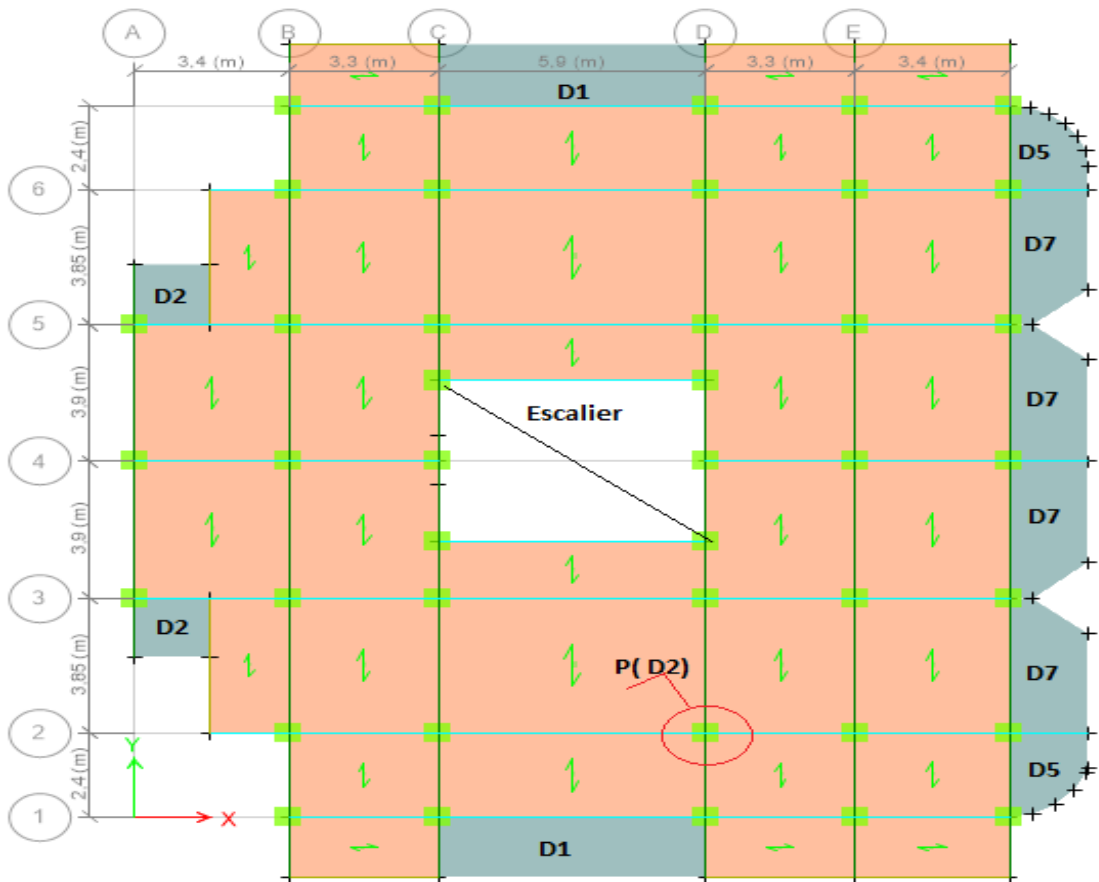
Plan de disposition des poutrelles (Étages 4 à 8)
